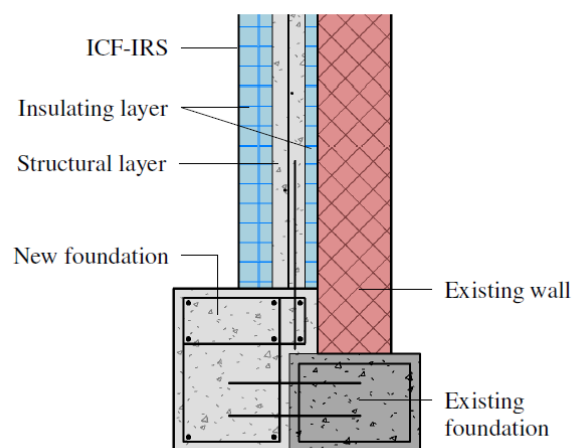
Dettaglio della nuova fondazione e del collegamento con quella esistente.
